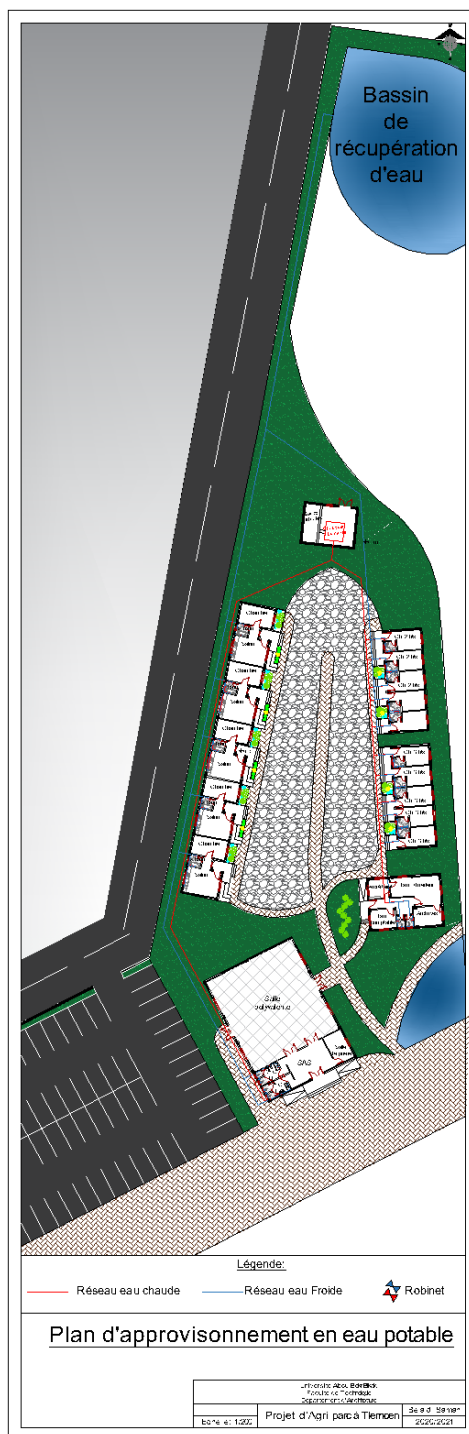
Plan d'approvisionnement en eau potable (Auteur).
